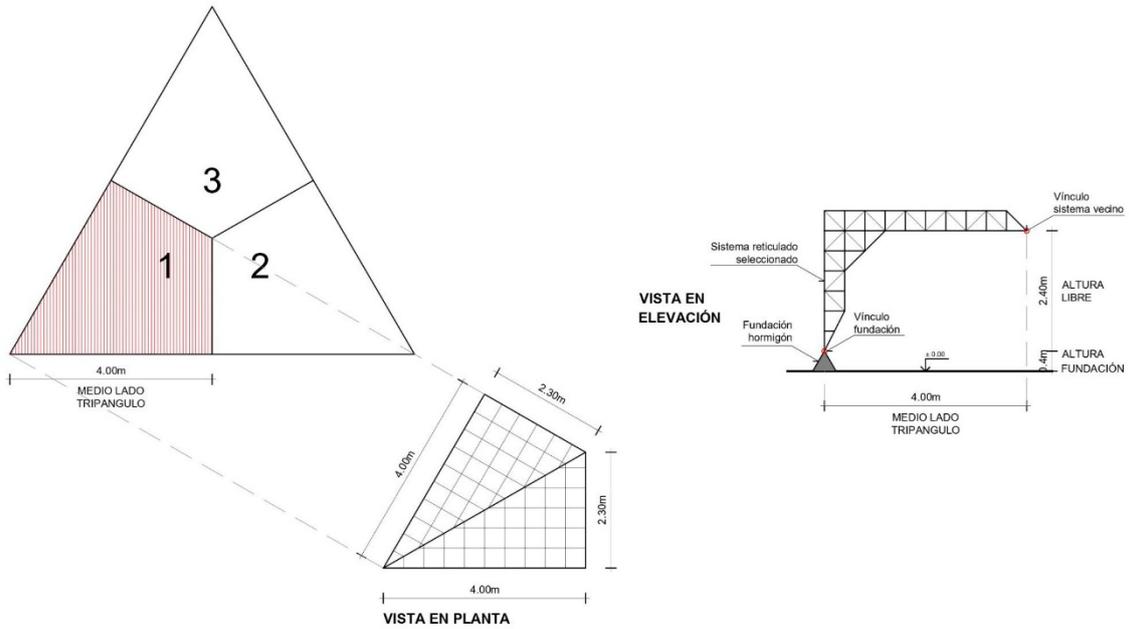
Encargo del primer semestre 2024 donde se especifican las dimensiones y geometría de cada sección o tercio de cubierta que debe proponerse en el sistema reticulado. Fuente: Elaboración propia
